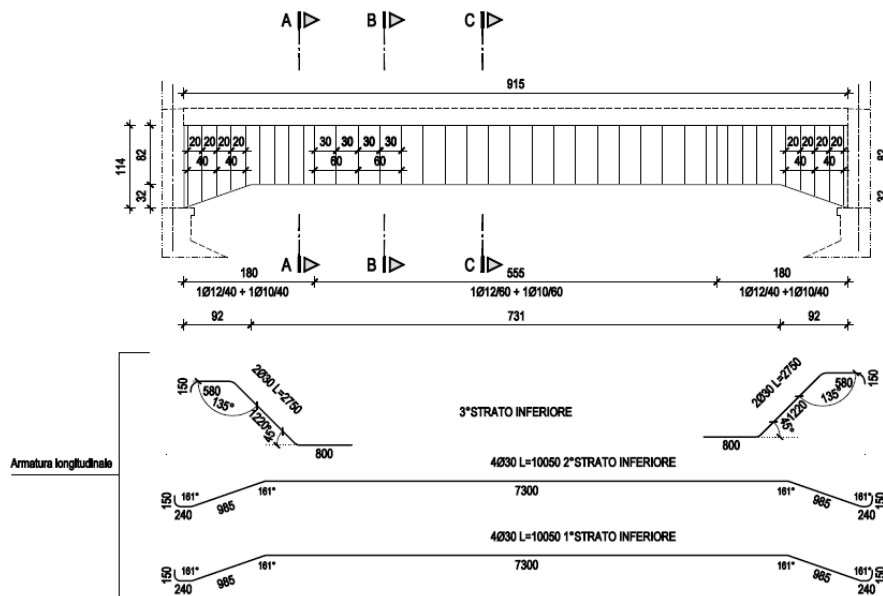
Rilievo geometrico dell'impalcato - Sezione trasversale ed indicazioni sulle armature
